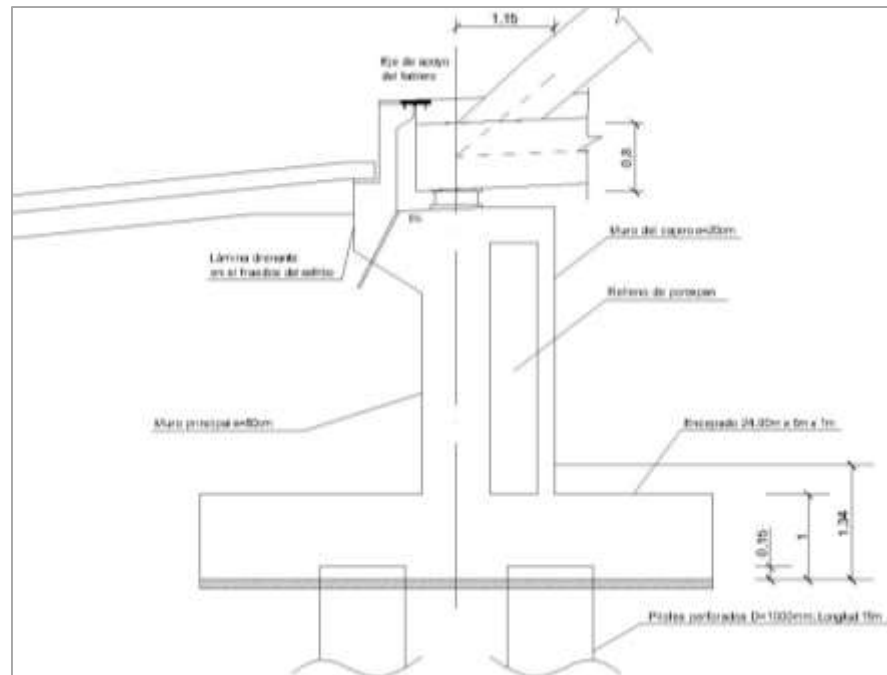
Sección tipo de ambos estribos (norte y sur). Fuente: Elaboración propia con AutoCAD.
